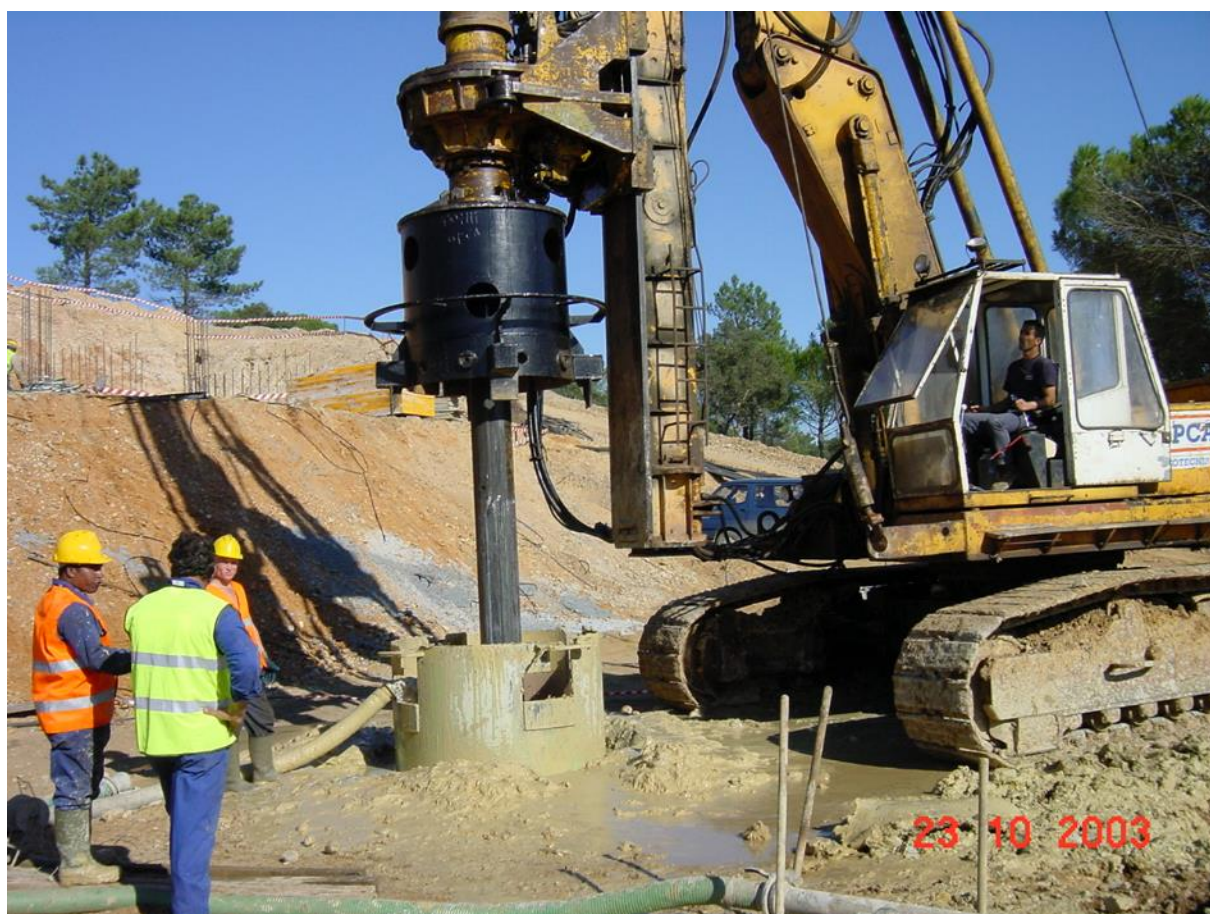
Escavadora de perfuração utilizada na construção de estacas moldadas
